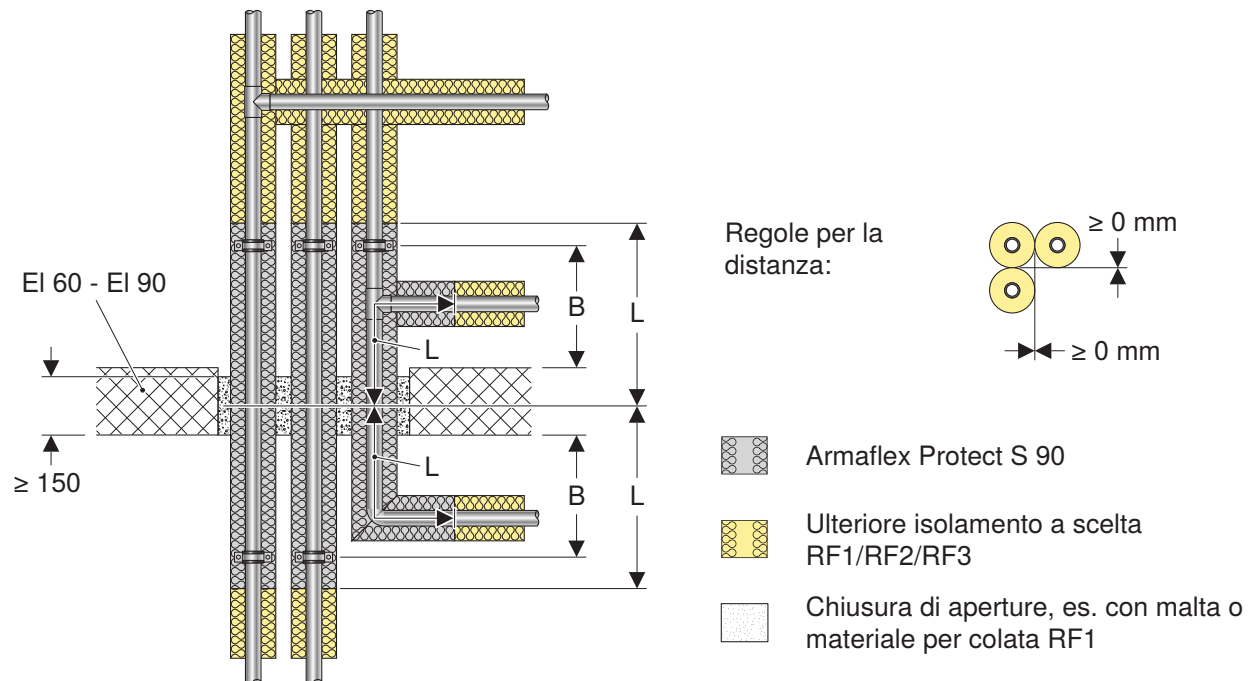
Attraversamento di soffitto con isolamento Armaflex Protect
